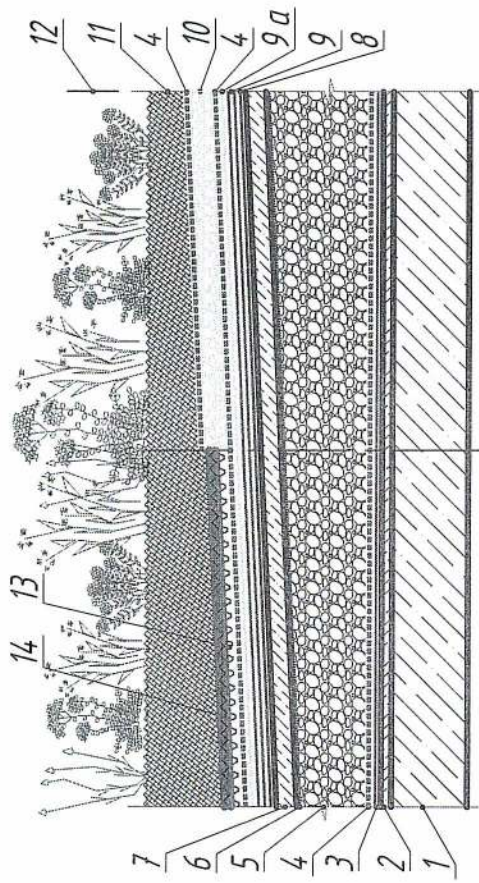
Принципиальная схема конструктивного исполнения настила бесчердачного покрытия выполняемого по железобетонному основанию (эксплуатируемая кровля с зелеными насаждениями)
